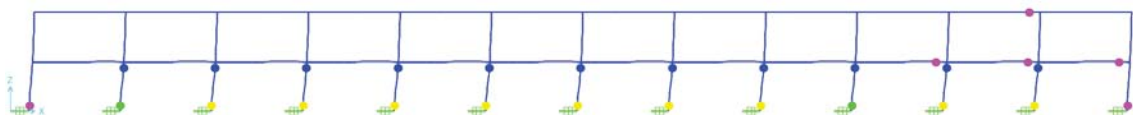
Secciones de columna en estado de Agotamiento – Aislado
